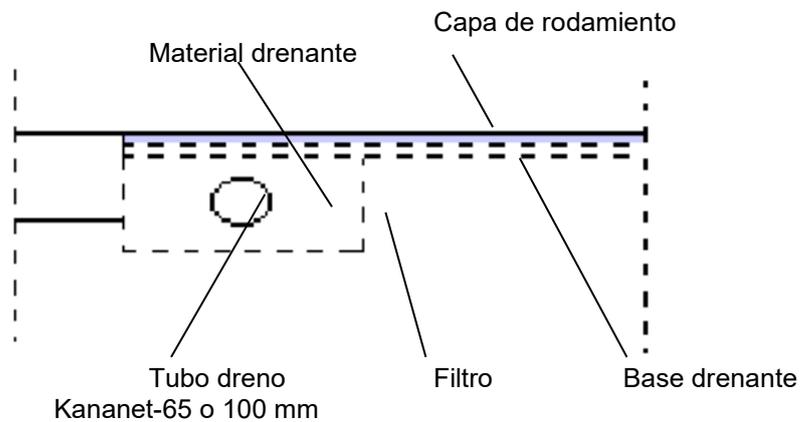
Corte esquemático de drenaje de pavimento de aeropuerto: para pistas estrechas, solo dos drenajes paralelos en los bordes del pavimento son suficientes; en pistas anchas, se utilizan una o más espinas de pescado.
